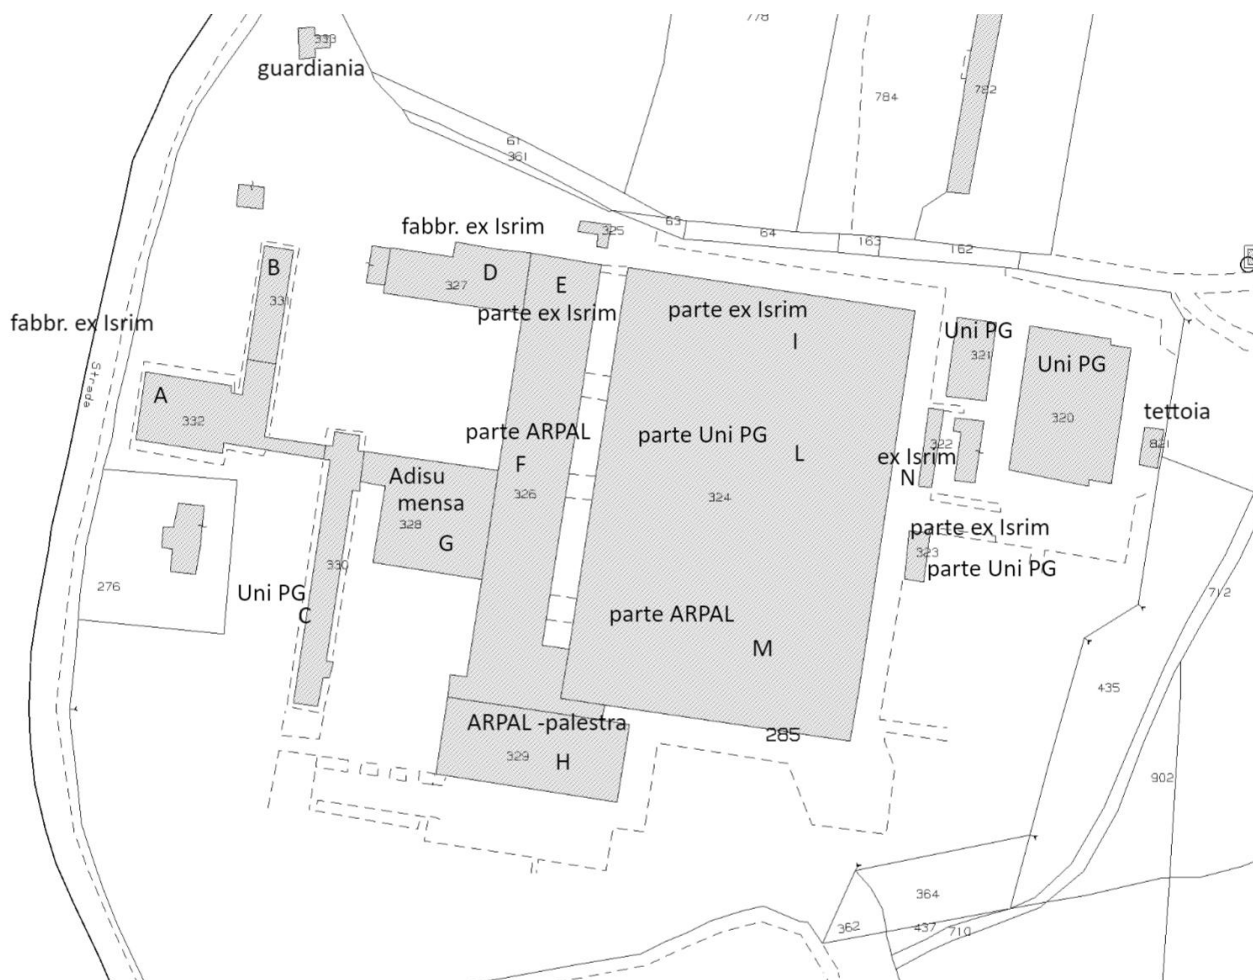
Planimetria generale, su estratto di mappa catastale, con la distinzione dei fabbricati e delle parti utilizzate
